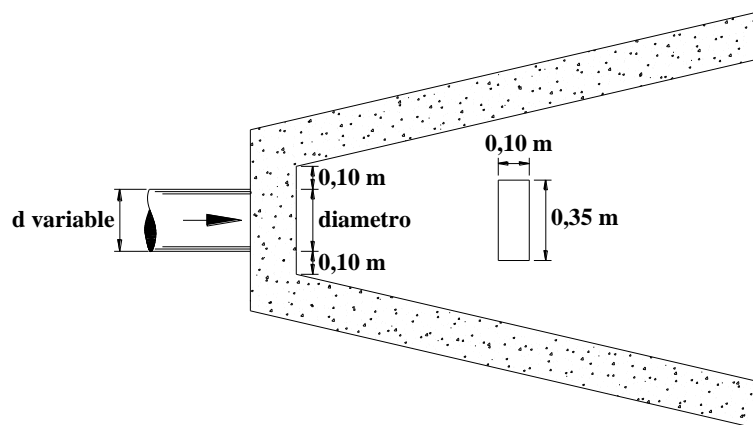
Planta de la Estructura de Hormigón para la Descarga
